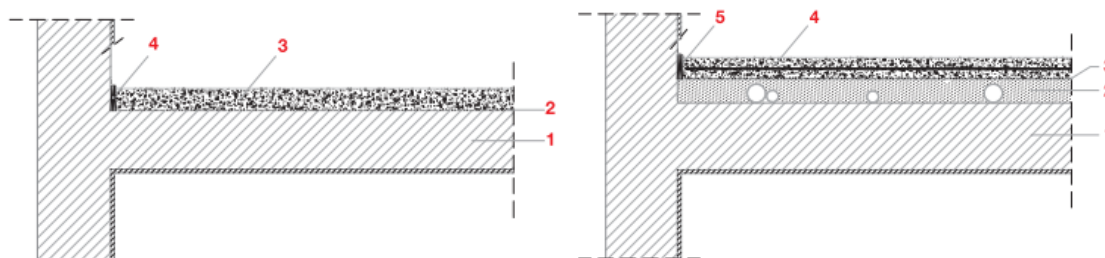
Betonilha não Aderente. Esquerda: 1)Laje; 2) Folha de polietileno; 3)Betonilha de espessura $\geq 3,5$ cm; 4) Material compressível. Direita: 1)Laje; 2)Betonilha de enchimento; 3)Folha de polietileno; 4) Betonilha de espessura $\geq 3,5$ cm com rede eletrossoldada; 5)Material compressível. Soluções construtivas MAPEI (12).
